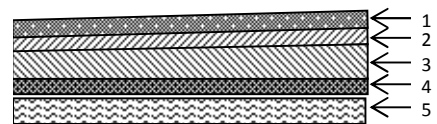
coupe verticale due aux plancher terrasse accessible.
